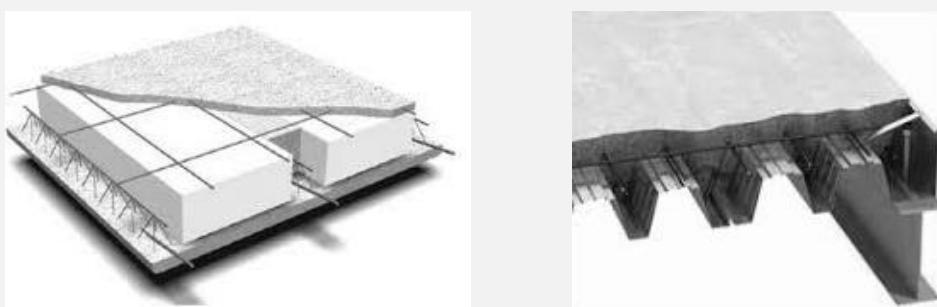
Tipuri de planșee din b.a. (Predală) și planșee mixte oțel-beton.
